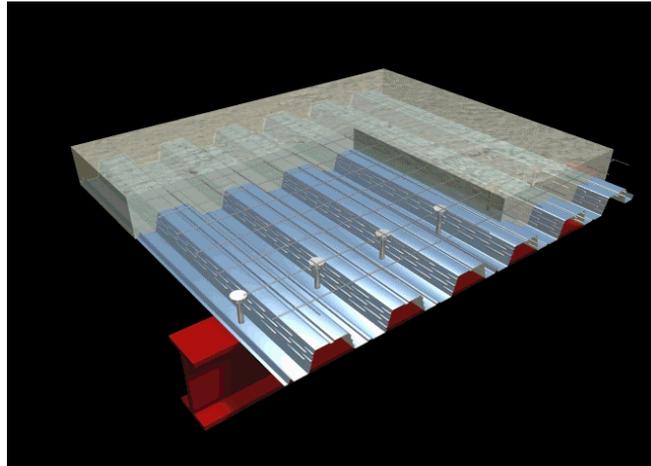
6: Corte transversal de uma seção com *steel deck
